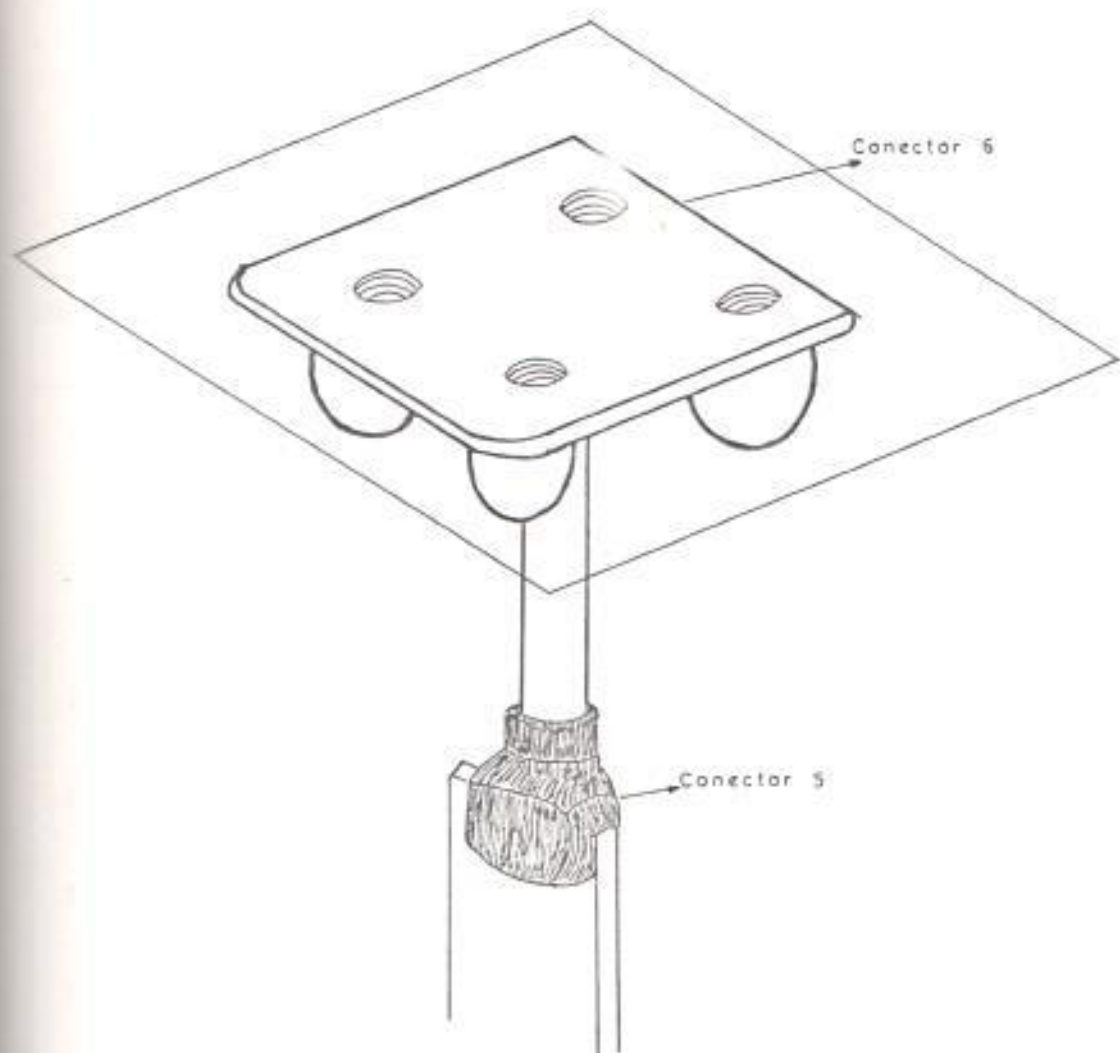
Detalle de conexión barra a plancha de cobre.
